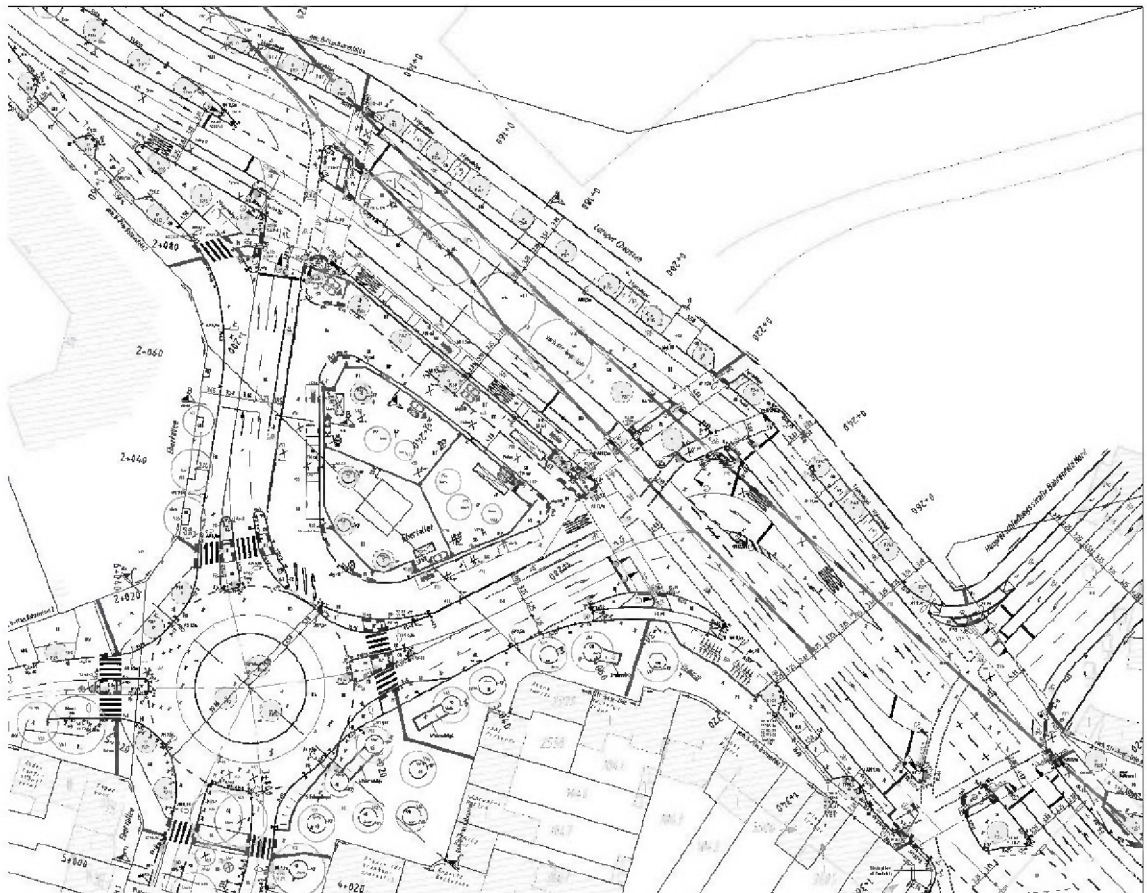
Signallageplan Luruper Chaussee/Ebertplatz – Umbau Endzustand (Vorentwurf) [14]
